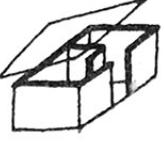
y 6.- CASETAS EN ALBAÑILERIA DE LADRILLOS ARMADA Y REFORZADA
